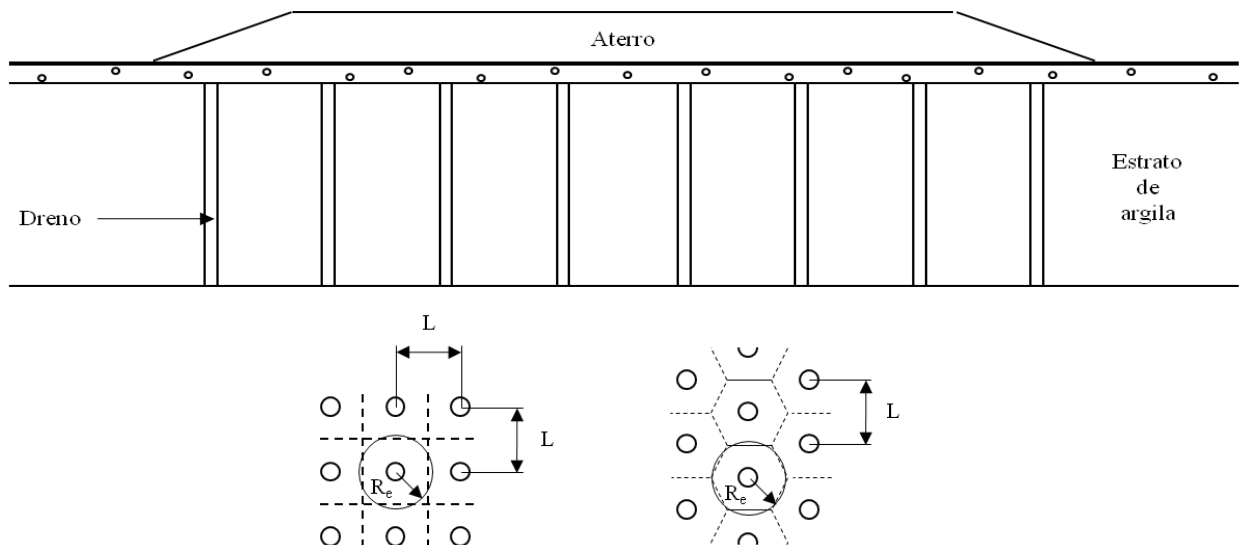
Esquema típico de uma solução de drenos verticais; malha quadrada e em quincôncio em planta.
